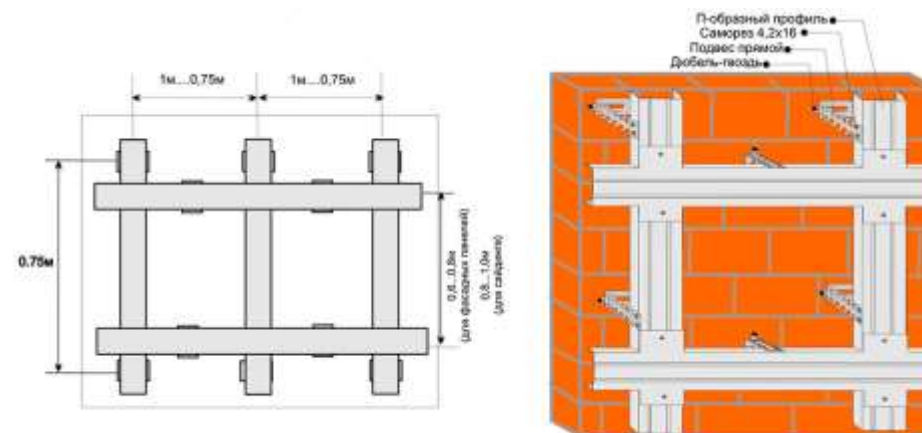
Вертикальный монтаж сайдинга и фасадных панелей
